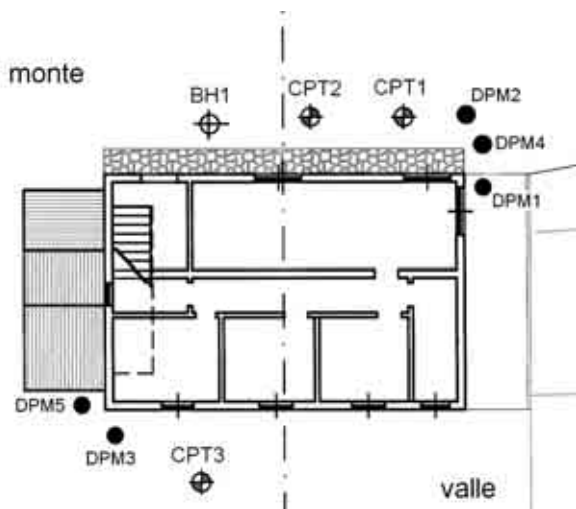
PLANIMETRÍA DEL EDIFICIO Y UBICACIÓN DE LAS PRUEBAS IN SITU.
